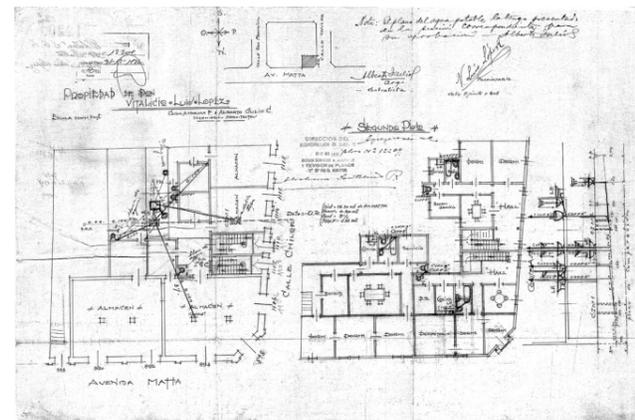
Plano de alcantarillado de 1926 del Caso 2.
